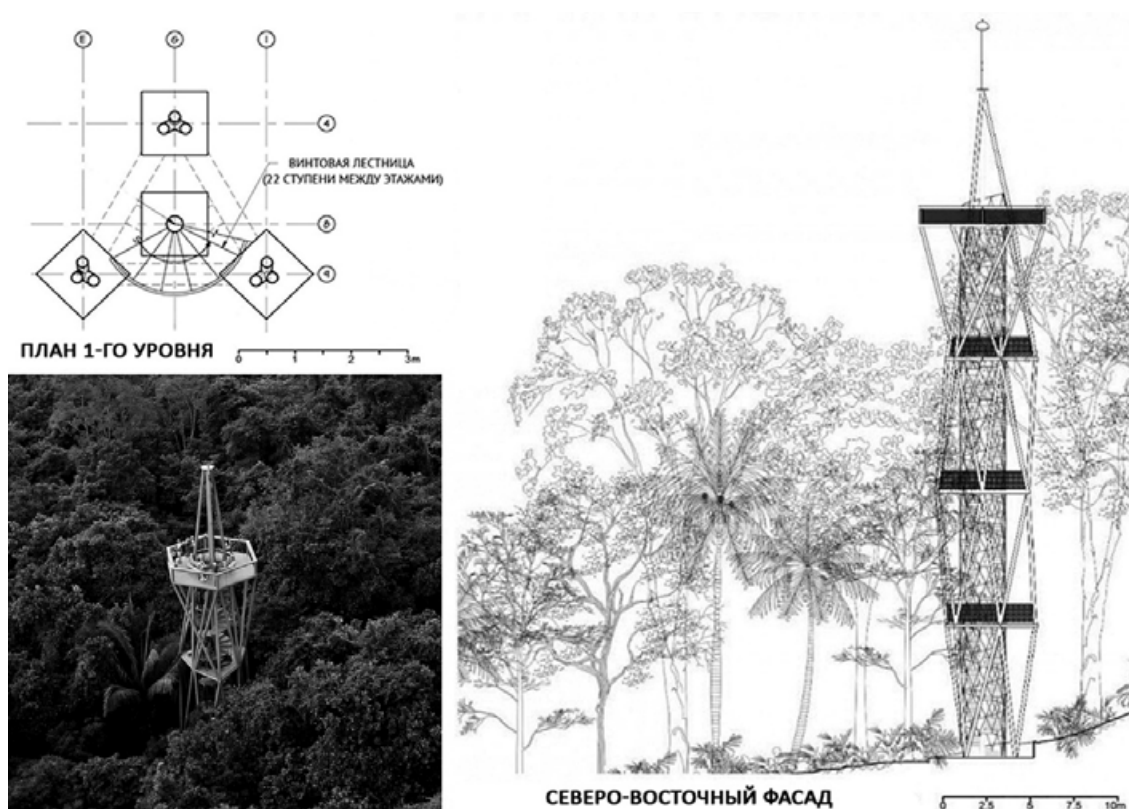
Схема плана, экстерьер и фасад смотровой башни в Панаме
